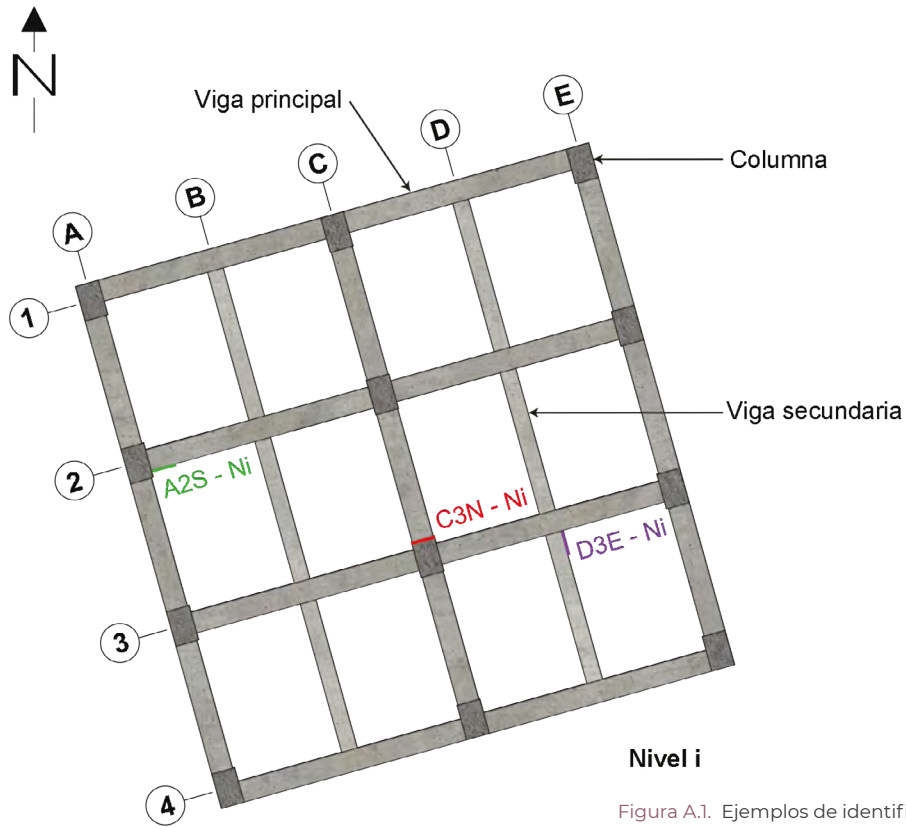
Ejemplos de identificación de elementos estructurales (columna, viga principal, viga secundaria) en la planta de un edificio cualquiera en el nivel i.
